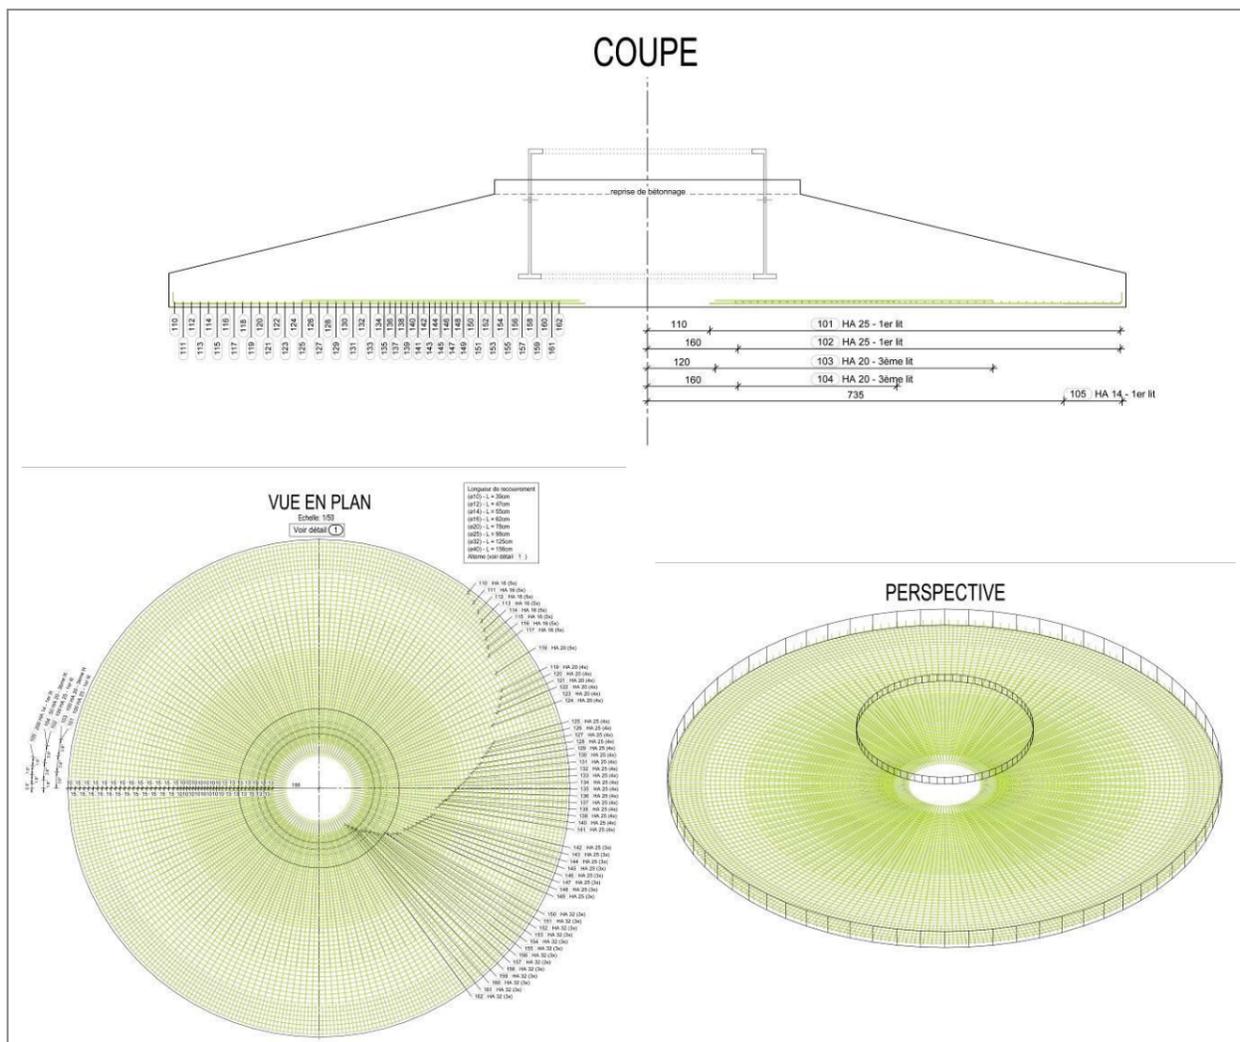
Coupe d'une fondation d'éolienne (Source Vestas)
